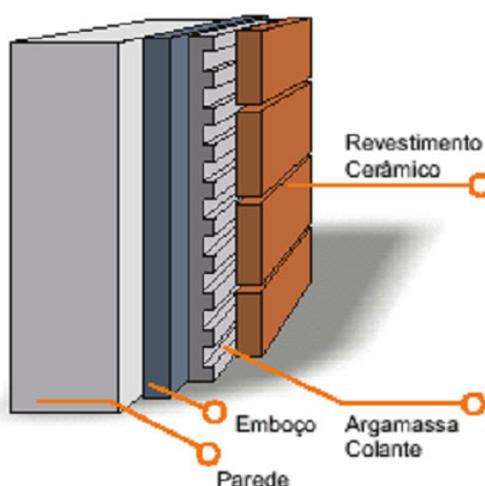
Representação esquemática da camada de argamassa colante aplicada entre a parede e uma placa cerâmica
